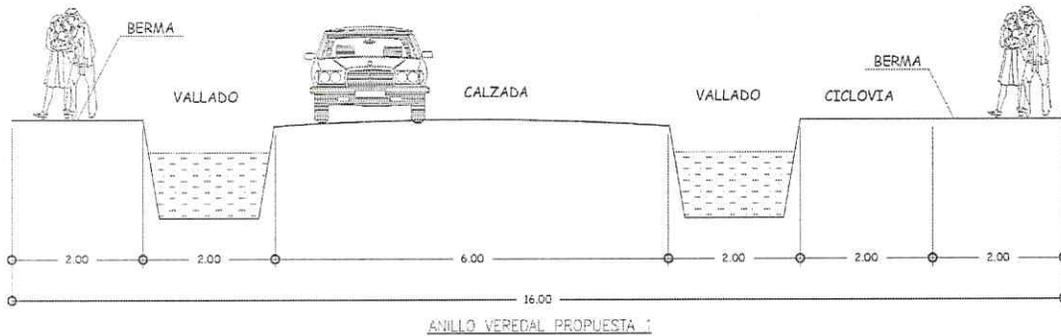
Perfil vial propuesto anillo veredal V-4
